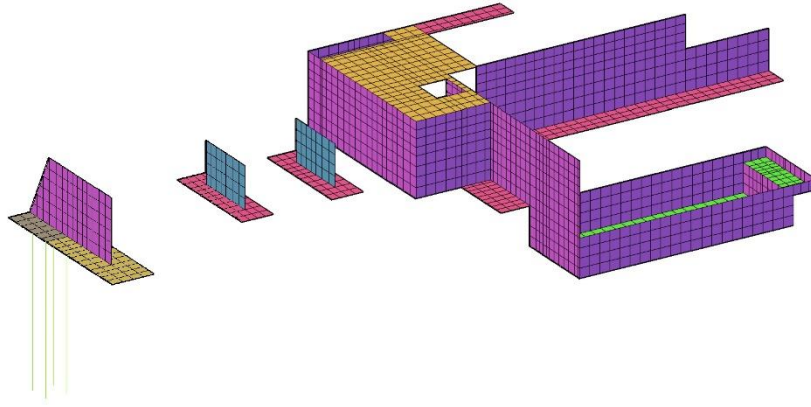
Geometría del modelo en AutoCAD. Cimentación y planta de acceso a garaje. Fuente: elaboración propia.
